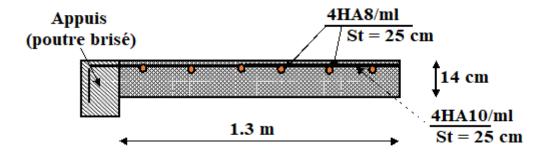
Schéma de ferraillage de l'escalier étage courant volée 1.
